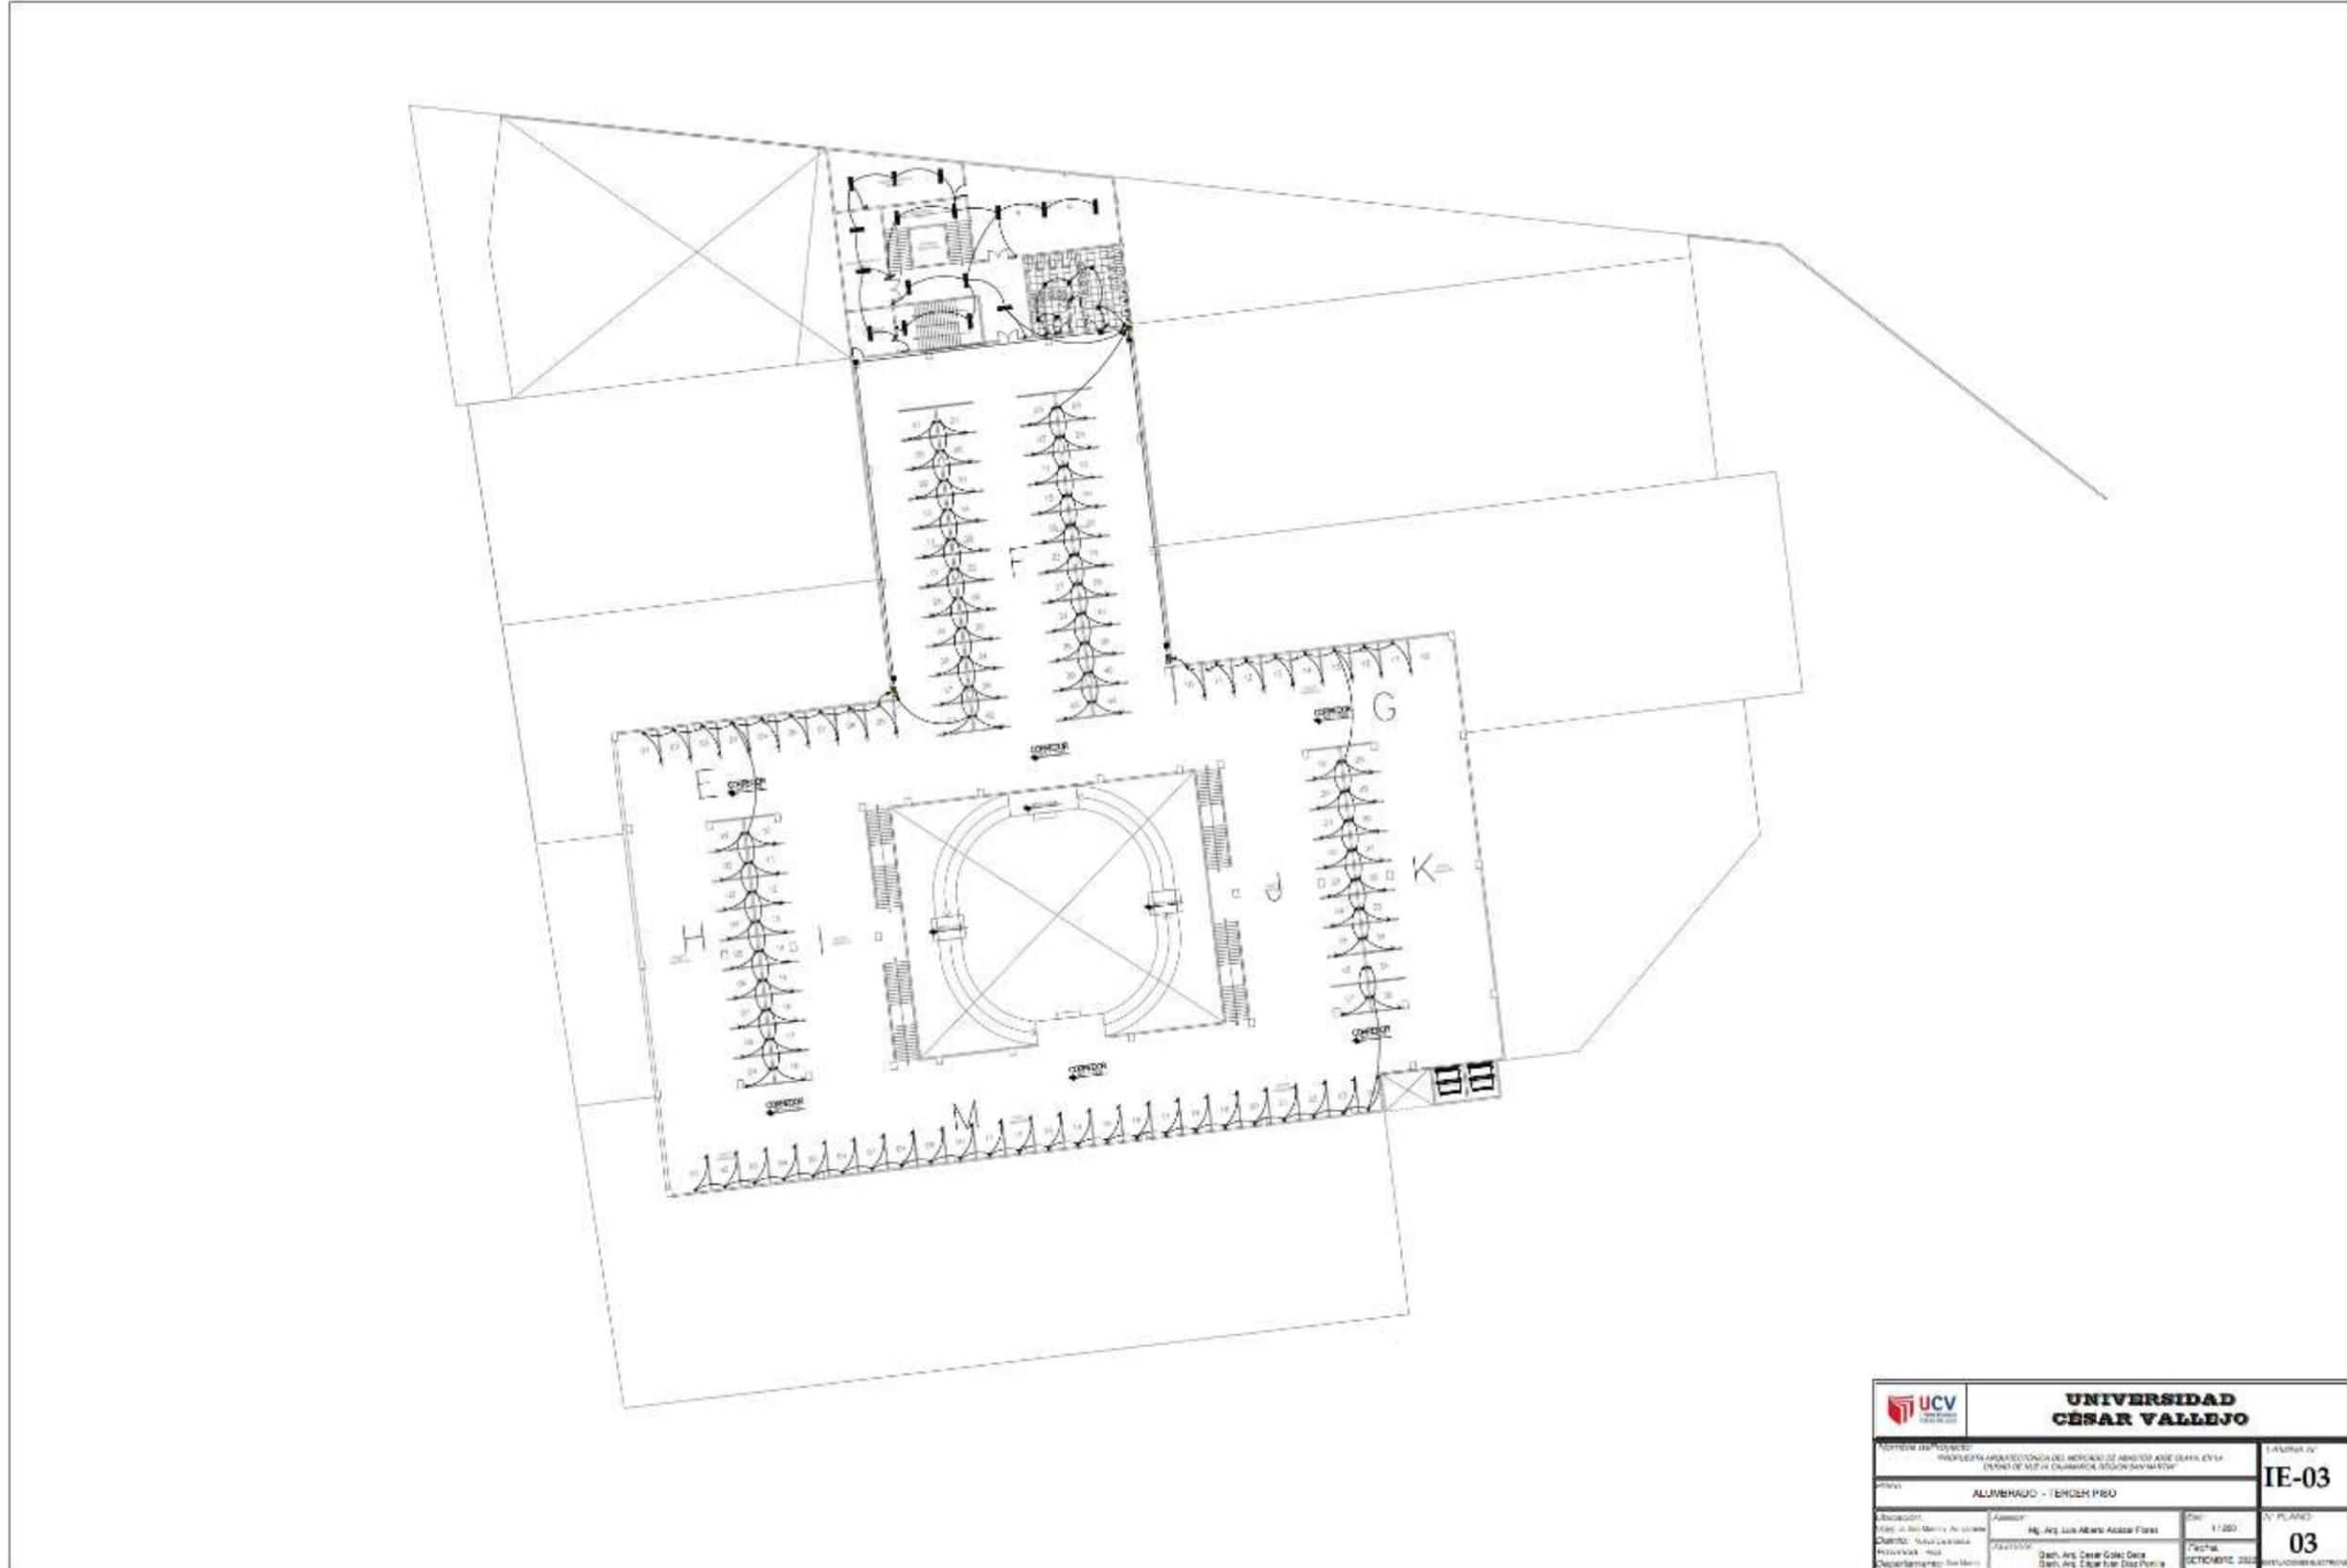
Plano de distribución de redes de instalaciones eléctricas – Alumbrado tercer piso
